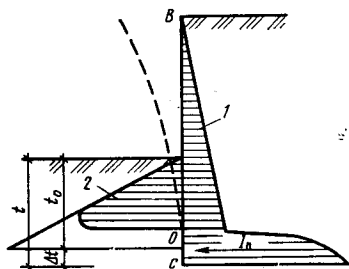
К расчету безанкерной шпунтовой стенки:
